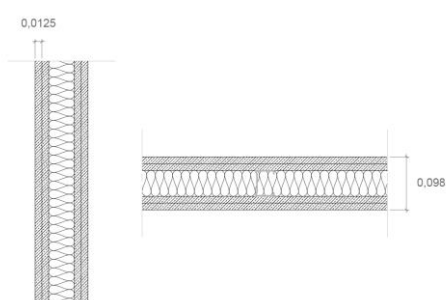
parede divisória interior em estrutura leve com 98 mm de espessura
